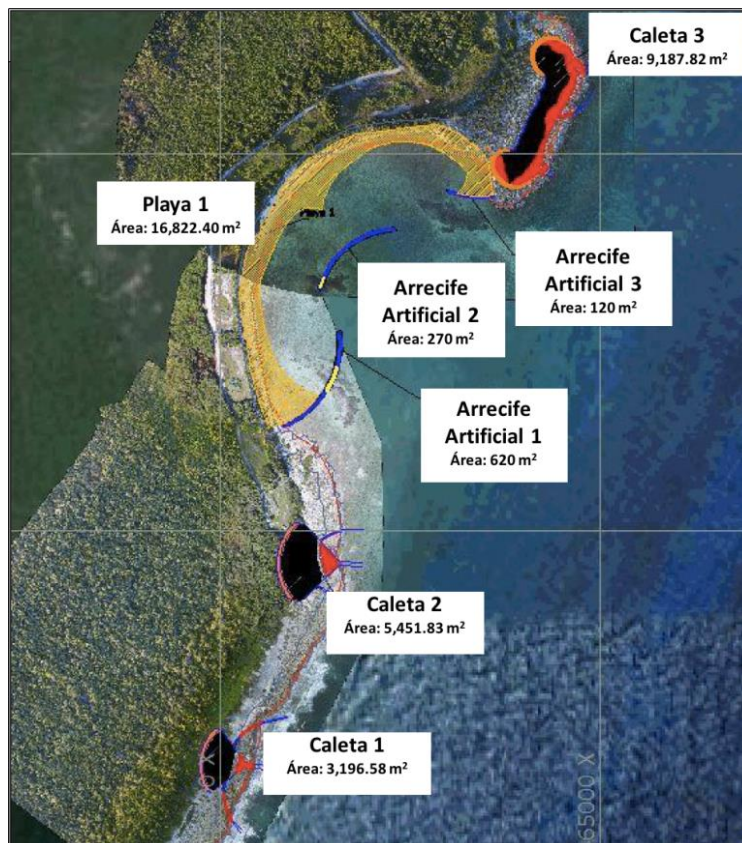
Vista general del proyecto, en la cual se puede apreciar la colocación de los arrecifes artificiales 1, 2 y 3, la construcción de las caletas 1, 2 y 3 y el vertido de arena en la playa 1.
